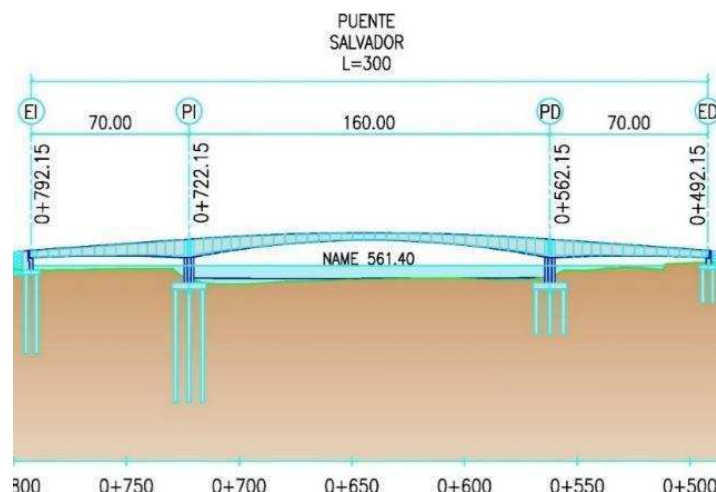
Características geométricas del puente Salvador Fuente: Consorcio HYC/MAB.
